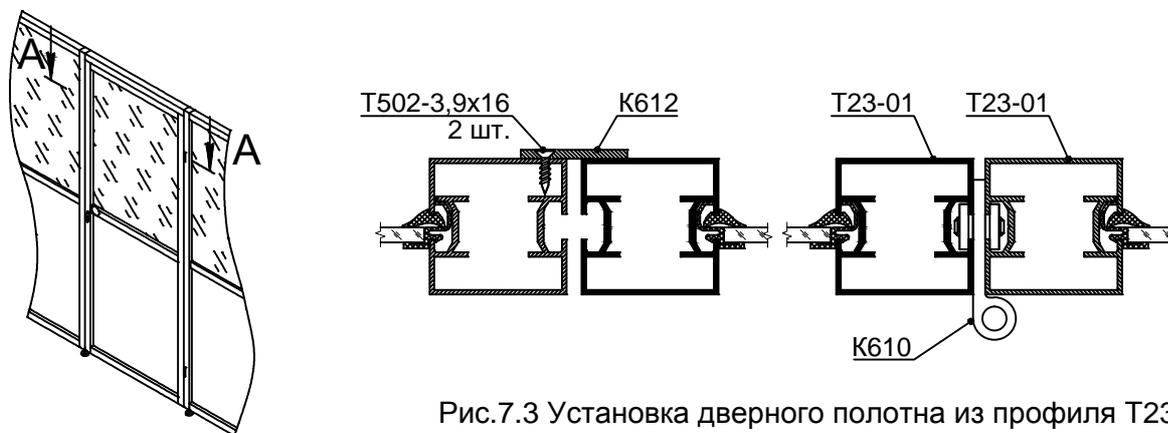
Установка дверного полотна из профиля T23-01 без использования дверной коробки
